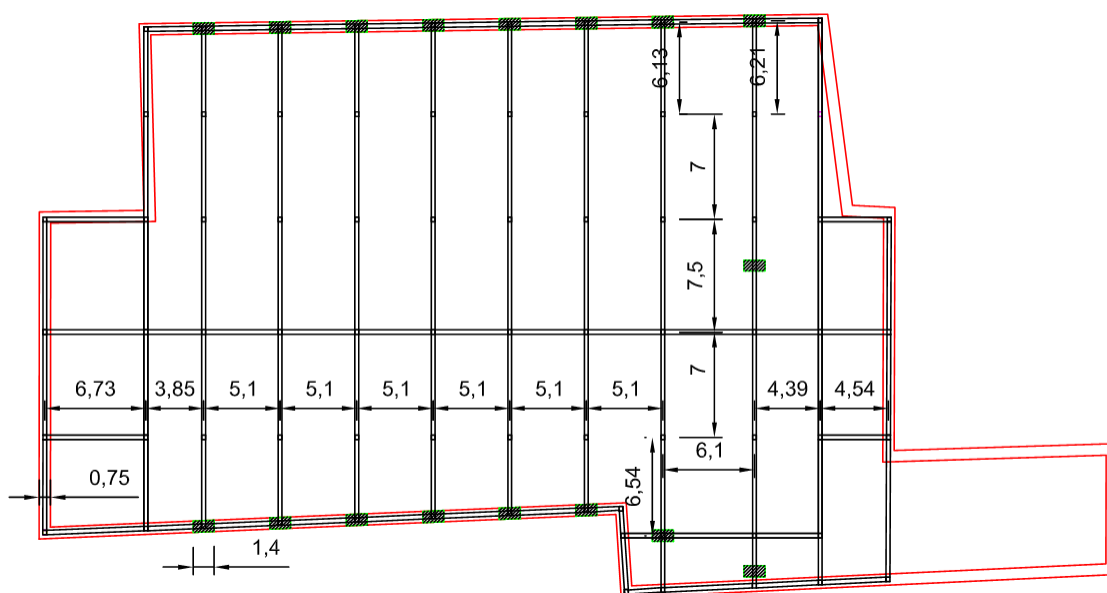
Esquema em planta do posicionamento dos elementos estruturais considerada
